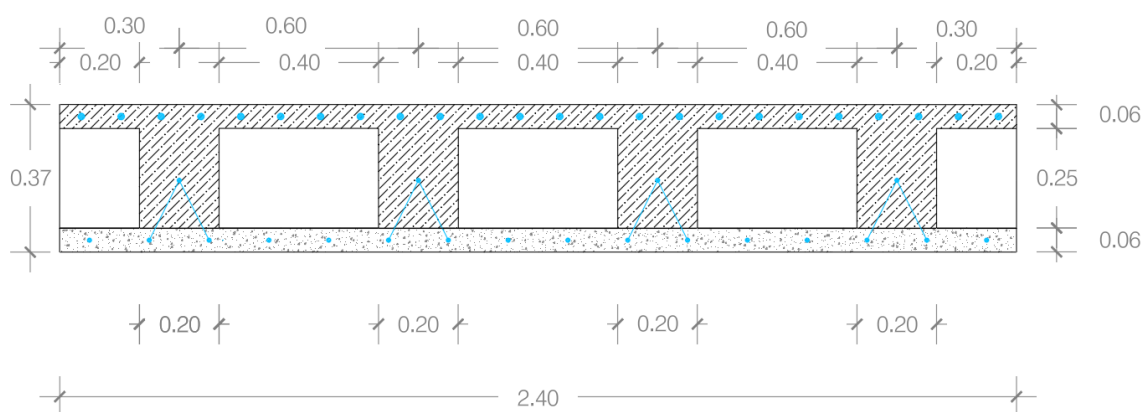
Solução da pré-laje aligeirada de vão interno
